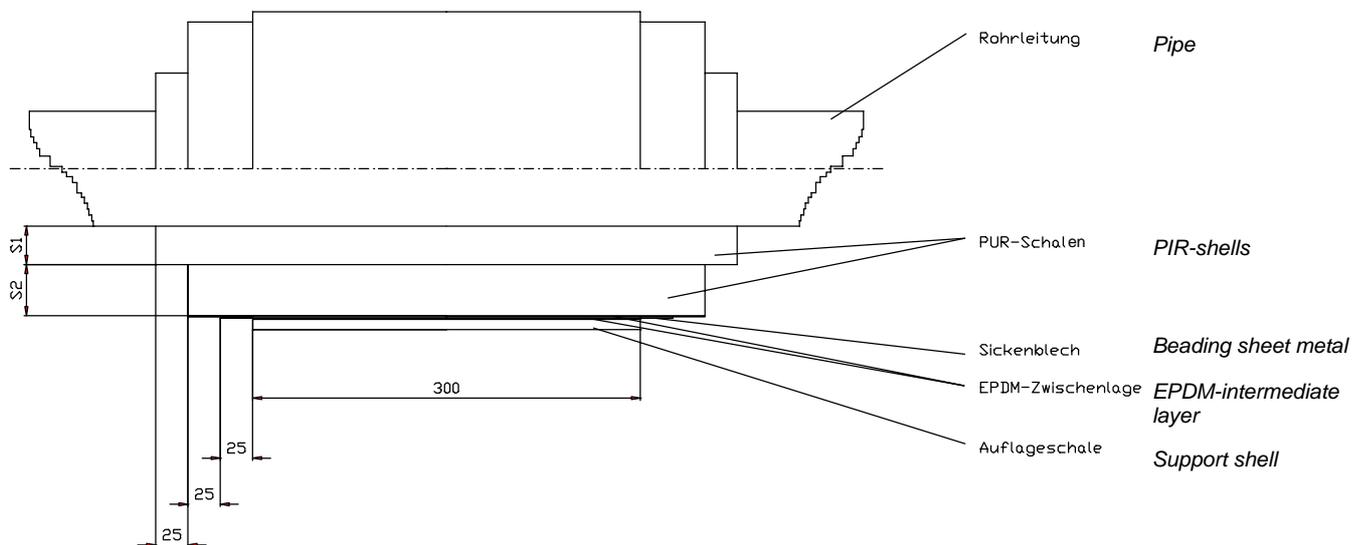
Überstände und Stufungen in Rohrachsrichtung an zweilagigem Isolierblock
